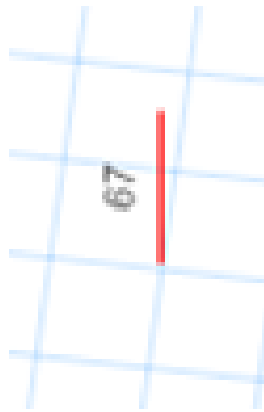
Фрагмент армирования колонны на отм. 0.000м до отм. 4.95 м по оси 2/а (площадь полной арматуры)
